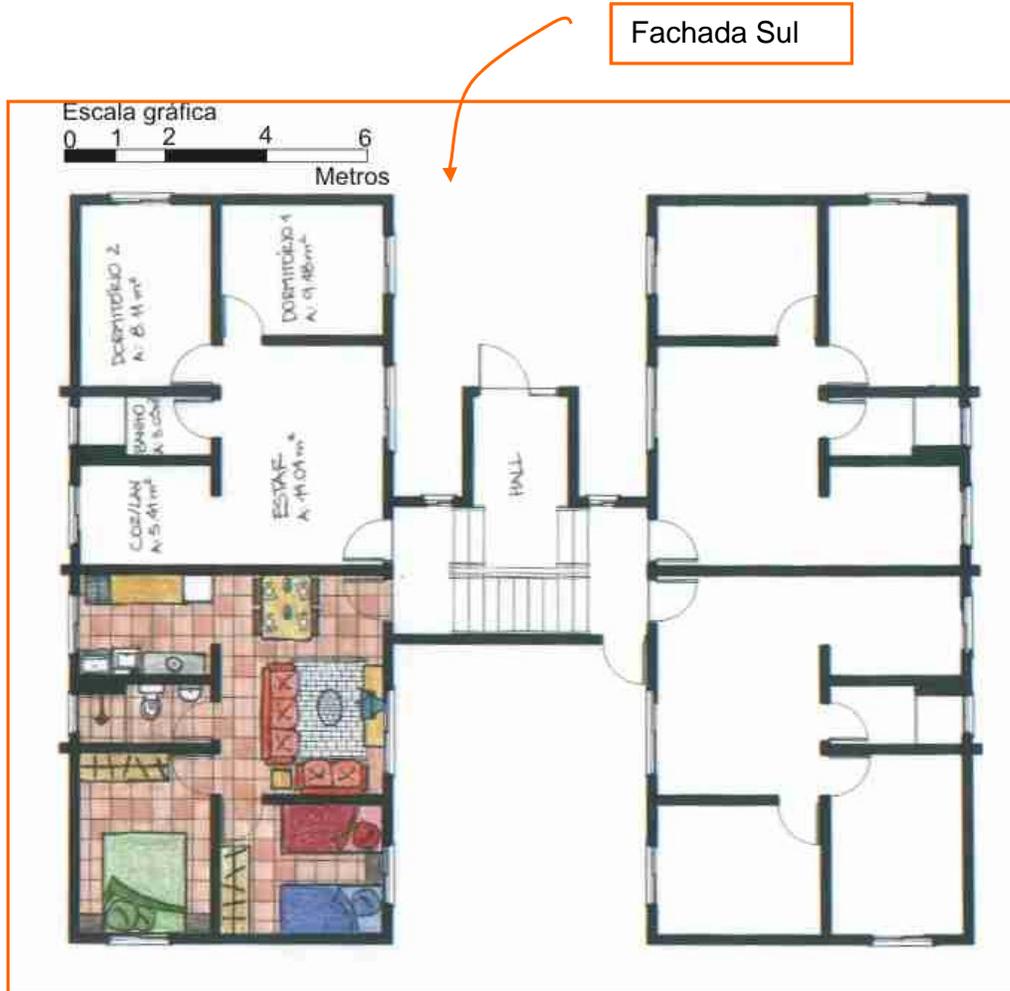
Planta baixa tipo dos blocos A, B, C e D.
